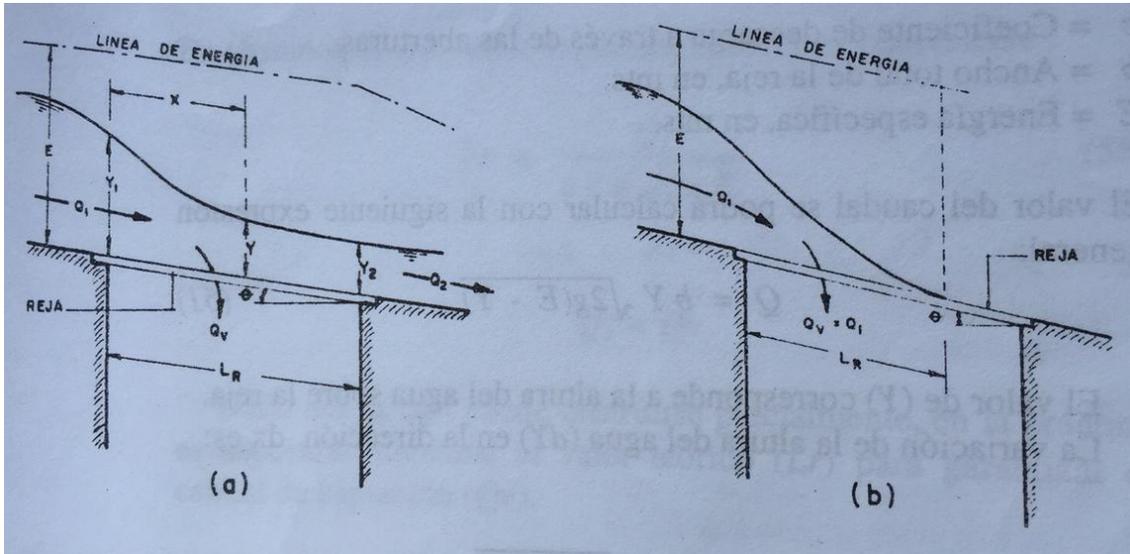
Distribución de canales en rejillas planas e inclinadas
